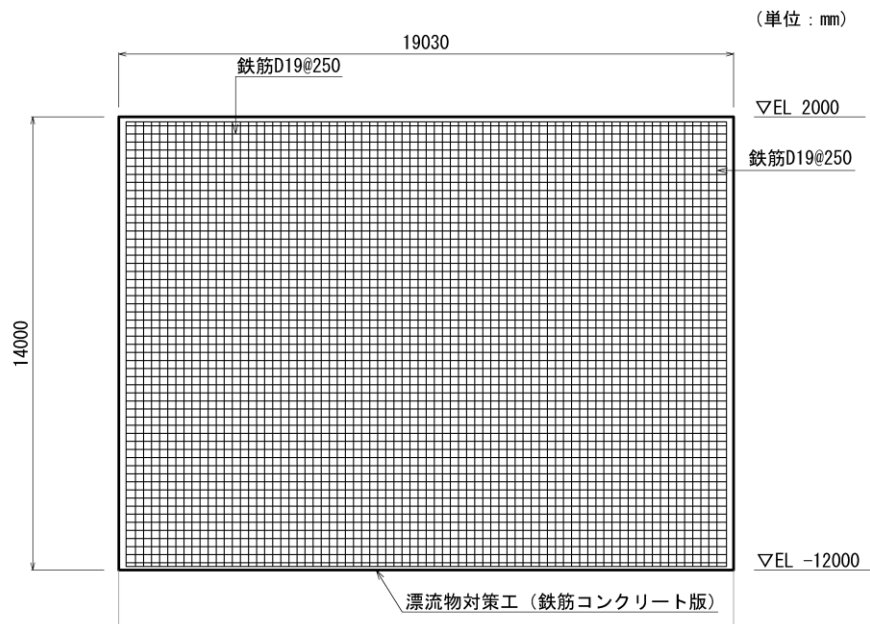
(3) 防波壁（波返重力擁壁）ケーソンにおける漂流物対策工（鉄筋コンクリート版）の概略配筋図（正面図）
